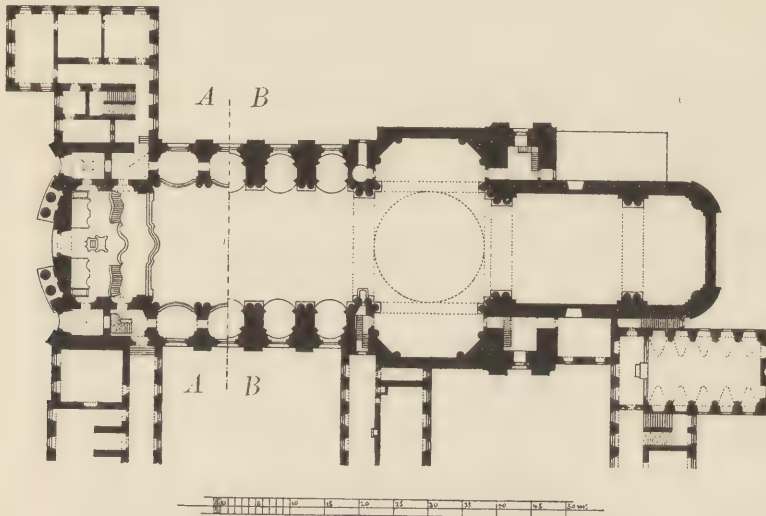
Klosterkirche zu Zwiefalten. Grundriss A, des Obergeschosses, B, des Erdgeschosses.
